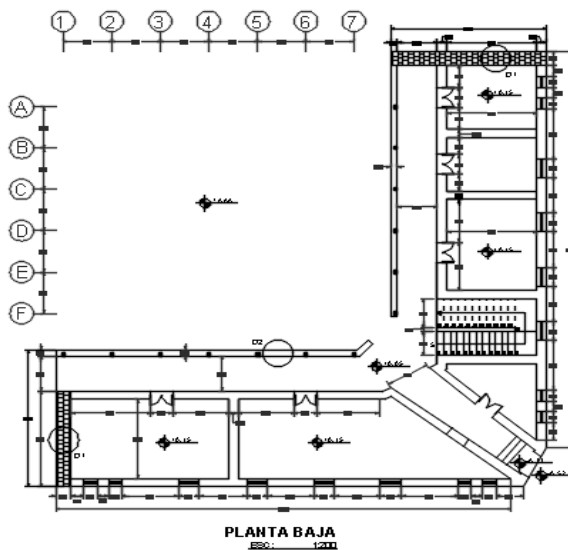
Planta Baja Bien inmueble Patrimonial.
